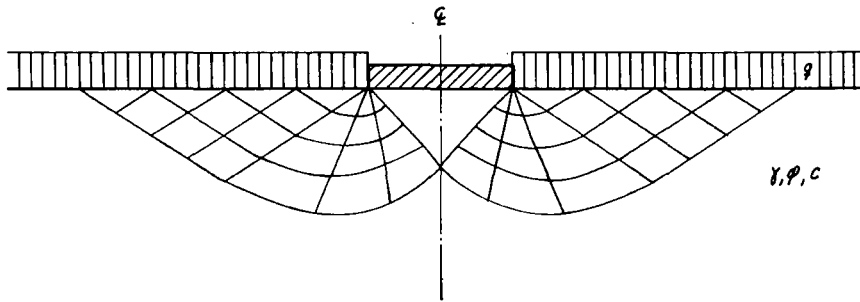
Brudfigur for stribefundament på tung friktionsjord med overfladebelastning.
